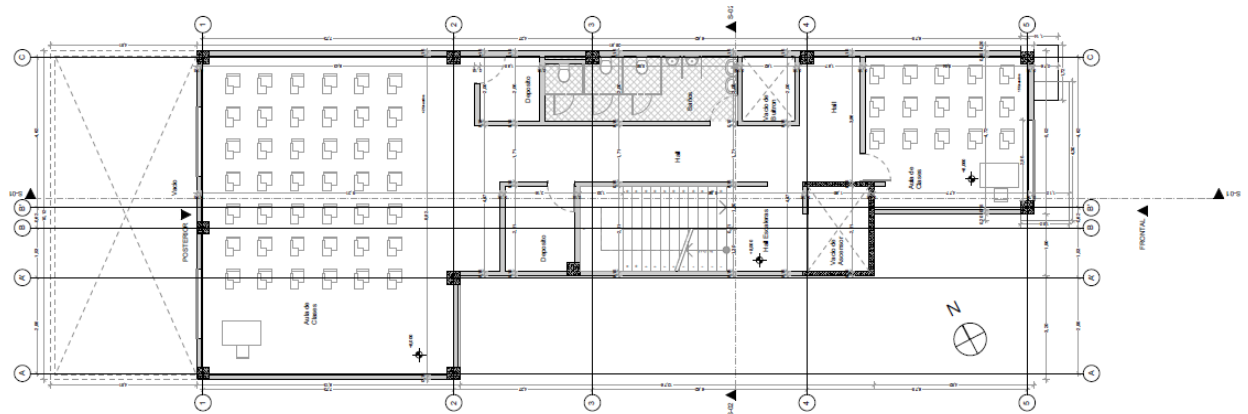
Planta Arquitectónica 2 Primer Piso Actual Cafaba.
